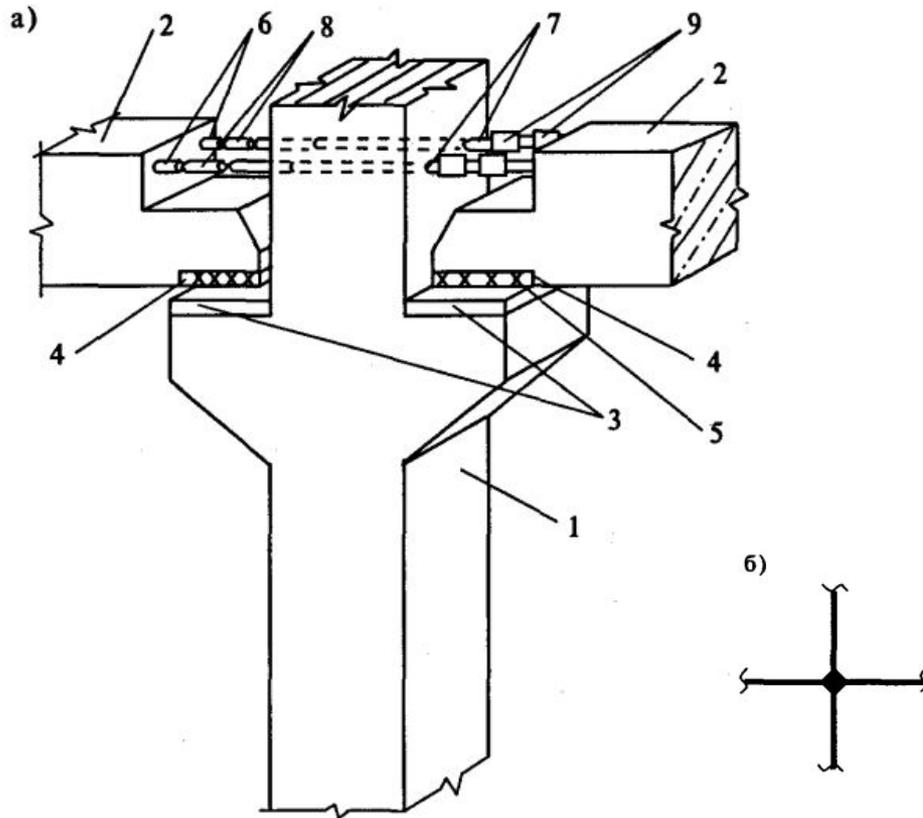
Шарнирное опирание стропильной железобетонной балки на колонну:
